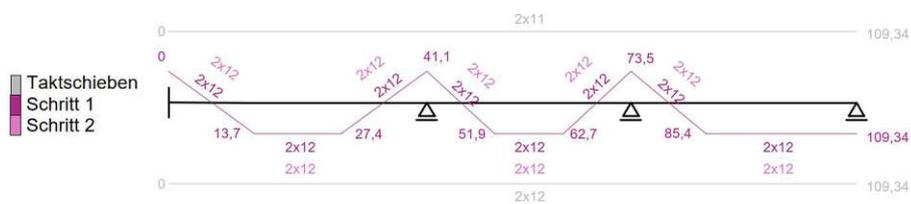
Vorspannung Betonagevariante D (Eigene Darstellung in Anlehnung an Raphaela Hackl [1])
